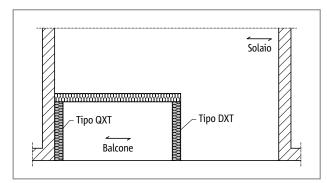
Schöck Isokorb® tipo DXT, QXT: solaio monodirezionale
